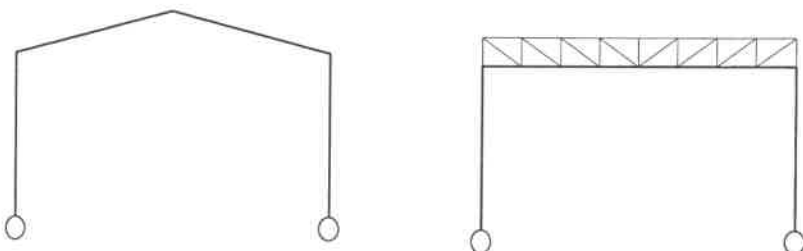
Rotules en pied de colonne et nœuds rigides pour les autres assemblages.
